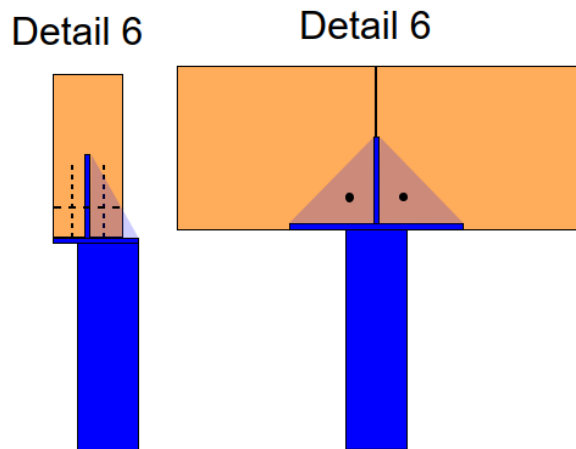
Anschluss Wandscheibe auf Stahlstütze (Ausführung 8 x)
